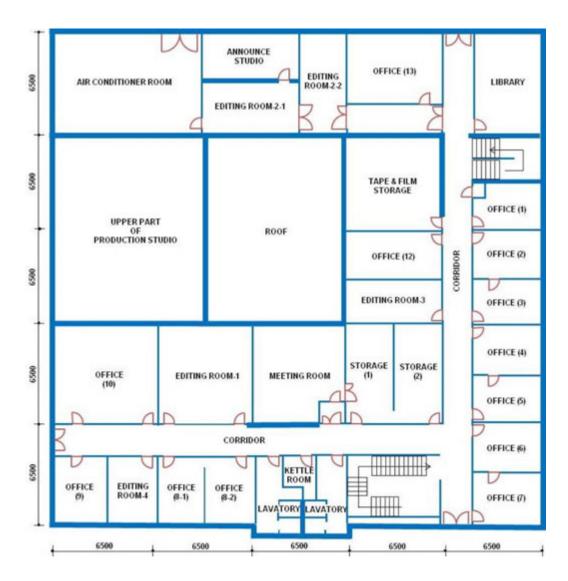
カブール・テレビ放送局 2 階平面図
